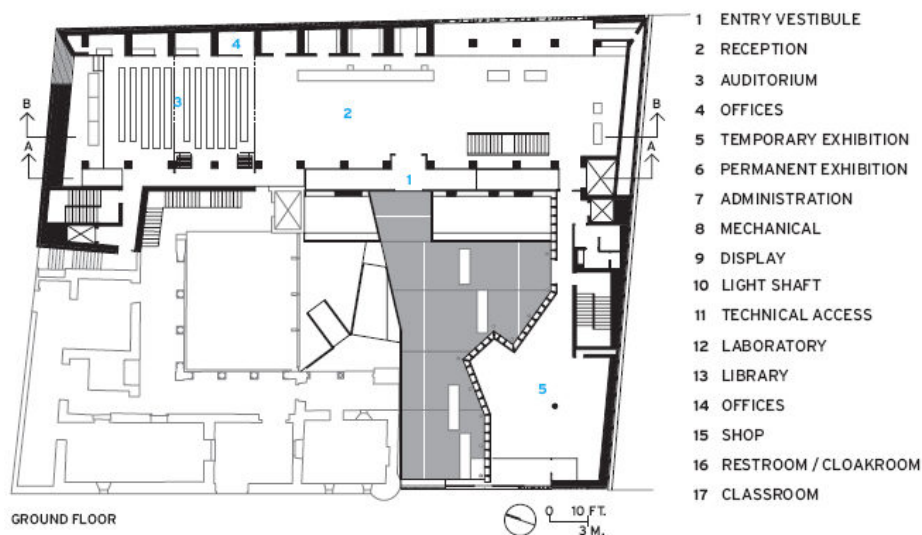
plan de RDC du musée d'Alava (archdaily.com).
